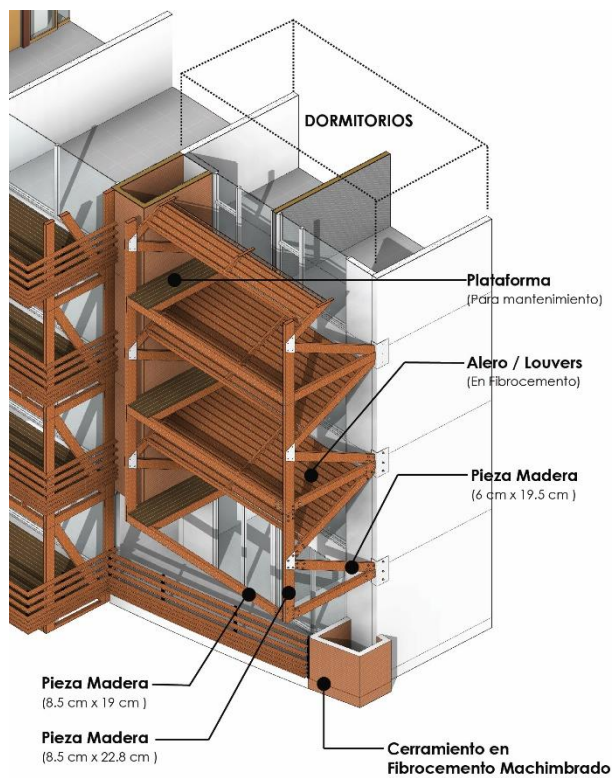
Detalle de Aleros / Louvers Fuente: Elaboración propia
